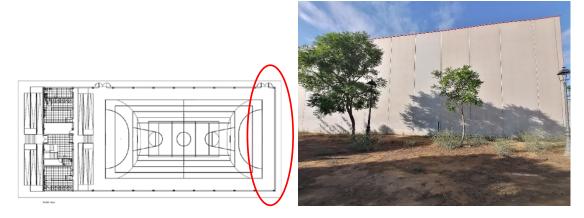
Muro del pabellón, fachada noreste, limitando con zona ajardinada
